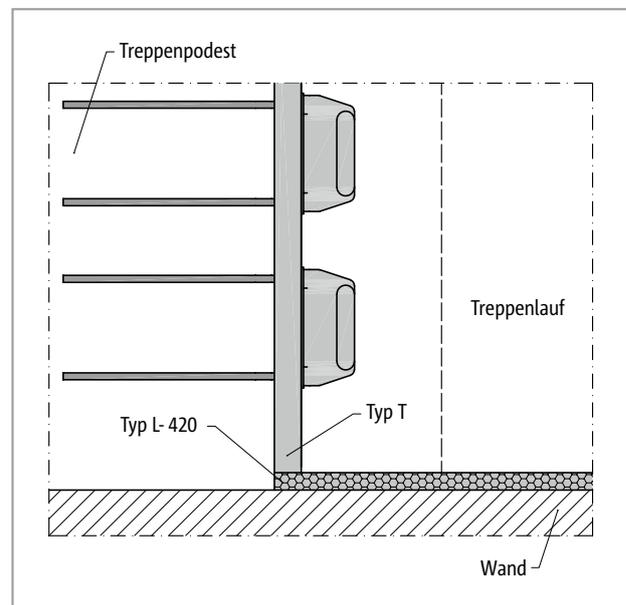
Schöck Tronsole® Typ T: Elementanordnung Detail B
